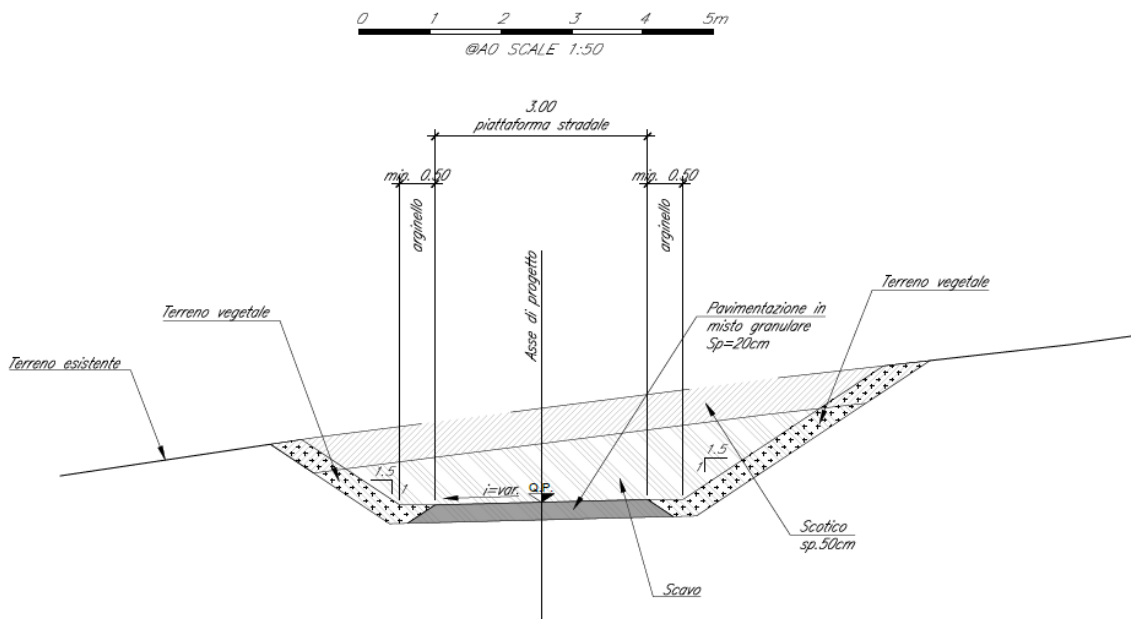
Sezione tipo NV11-Asse 4 in trincea
